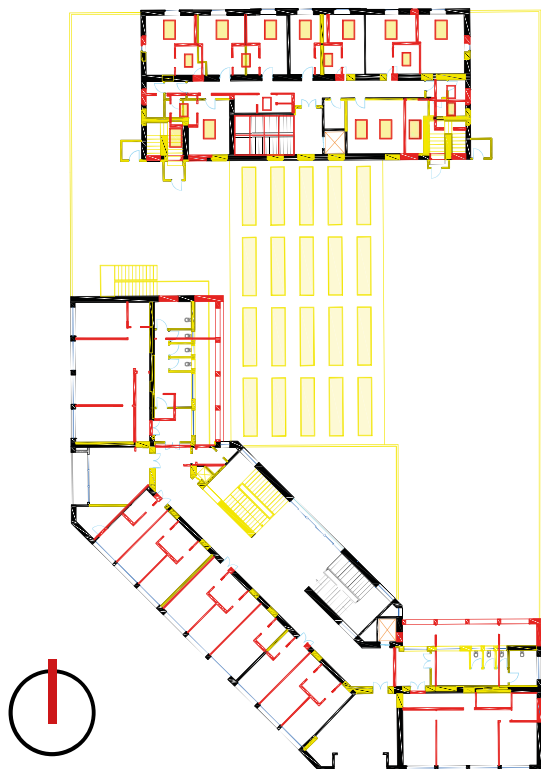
Schema demolizione costruzione, confronto Piano Tipo tra SdF e Progetto
